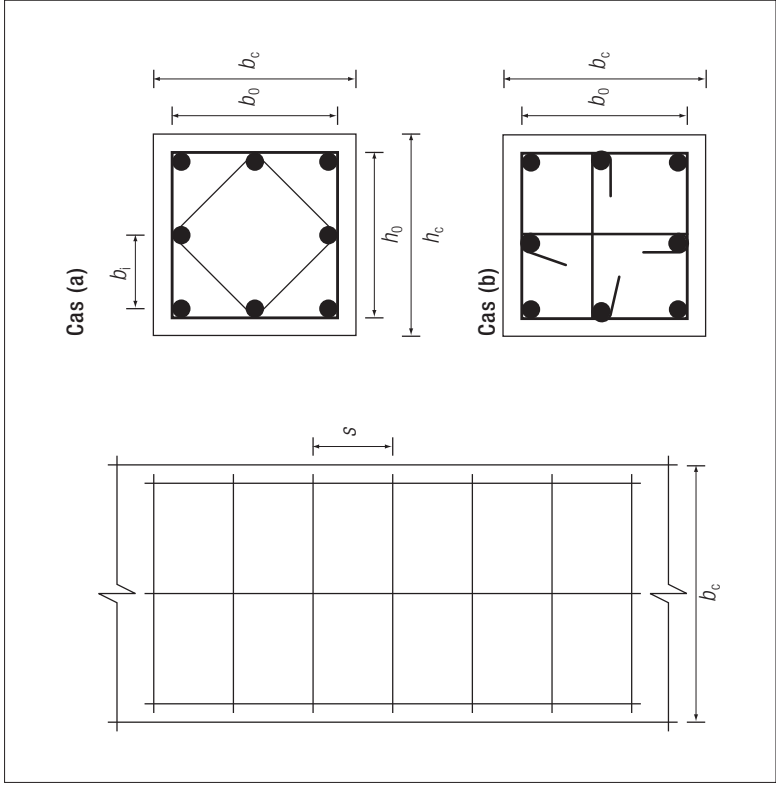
Dispositions typiques des armatures de confinement dans un poteau
